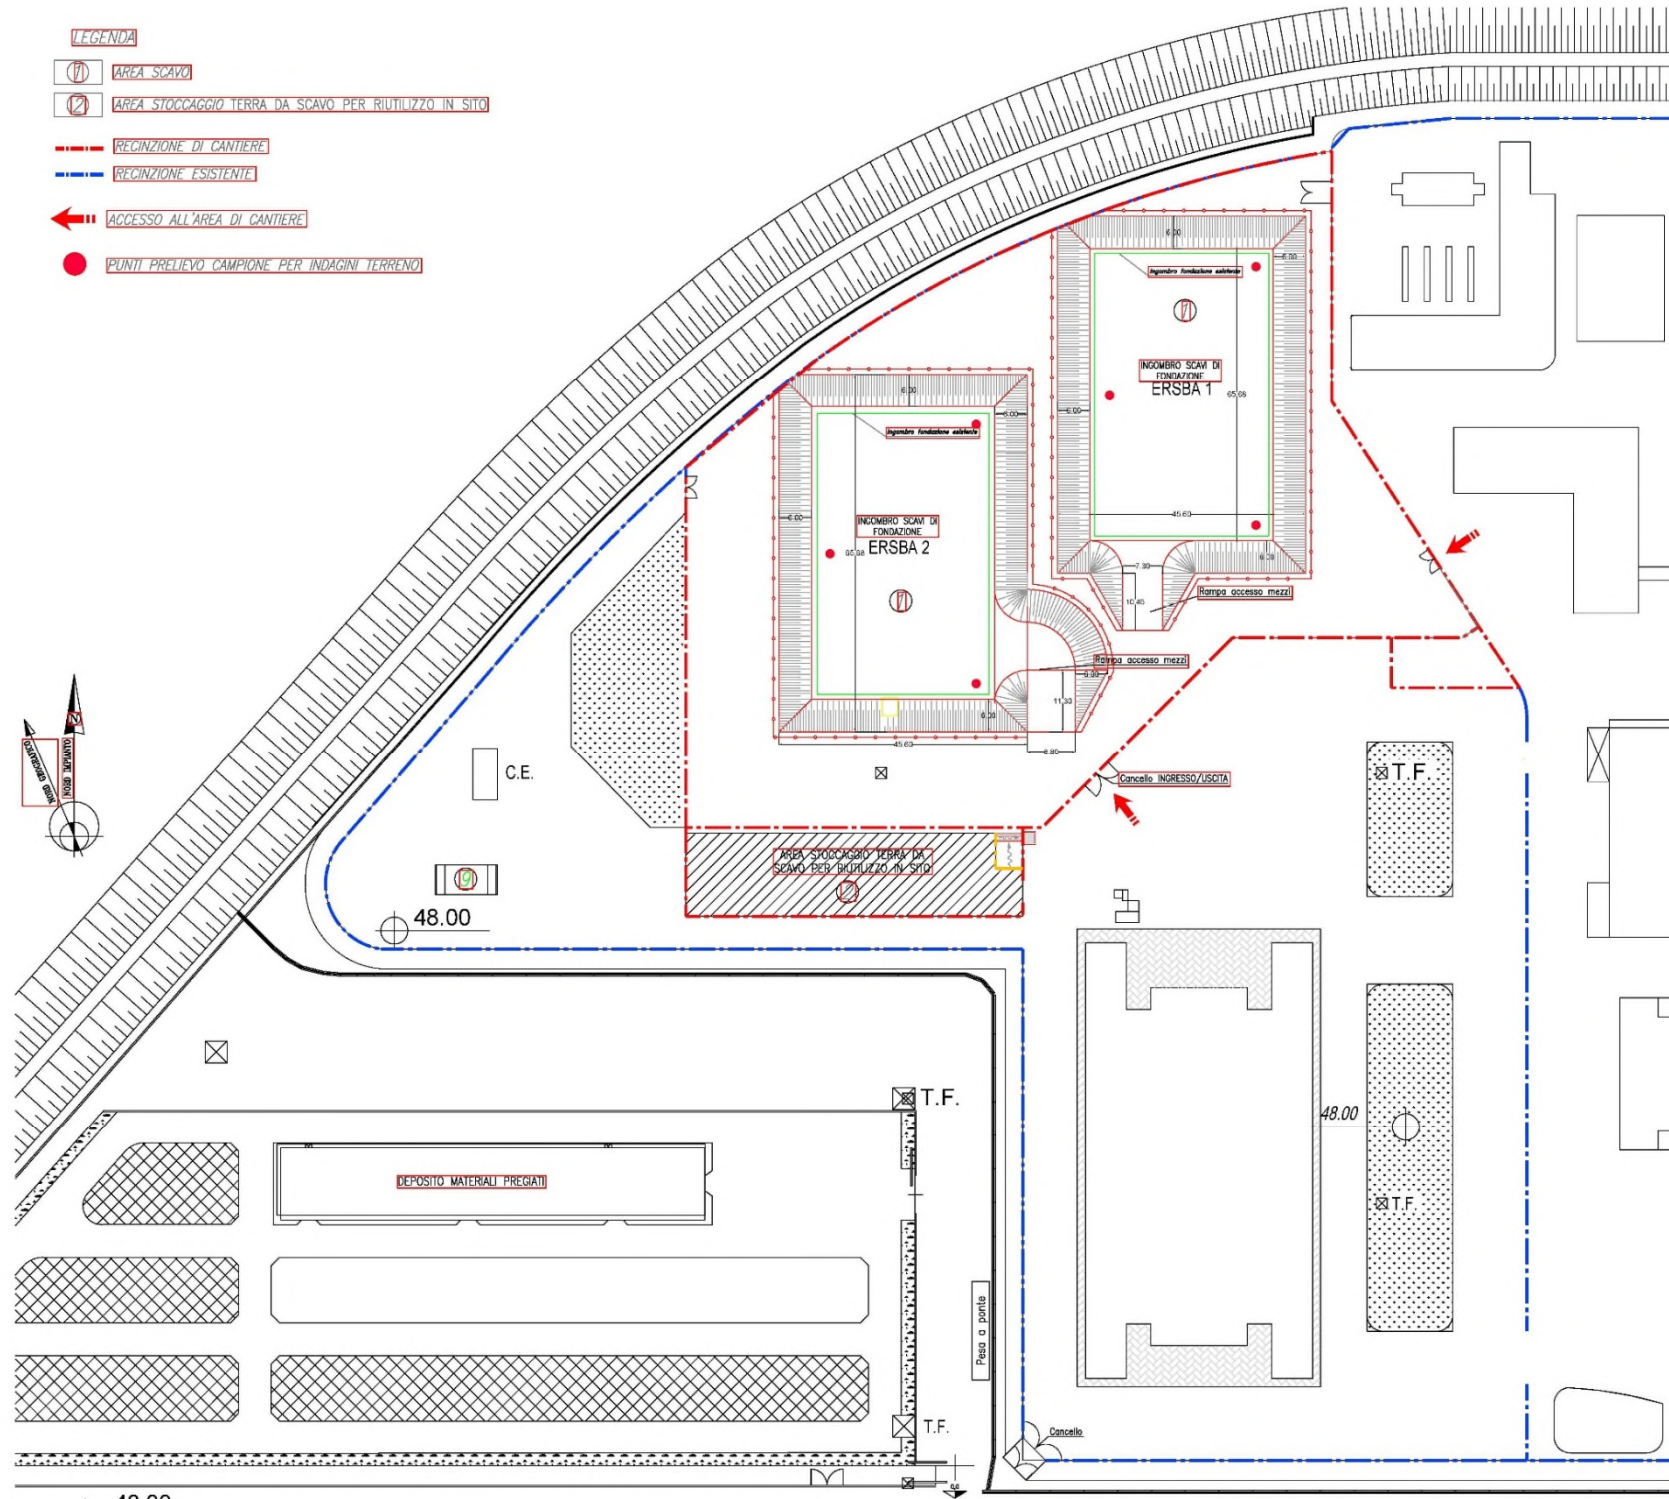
Planimetria dell'area di cantiere con ubicazione dei punti di sondaggio e dell'area di deposito delle terre in attesa di riutilizzo
